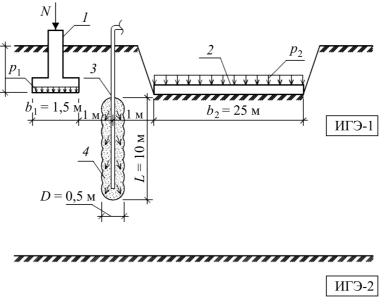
Расчетная схема оценки влияния разделительного ограждения на осадки ленточных фундаментов существующего здания: I – существующий ленточный фундамент; 2 – вновь устраиваемый соседний плитный фундамент; 3 – инъектор; 4 – тело грунтоцементной сваи;  $b_1, b_2$  – ширина подошвы фундаментов; d – глубина заложения фундаментов; L – длина разделительного ограждения;  $p_1, p_2$  – давление по подошве фундаментов; N – погонная нагрузка на фундамент
